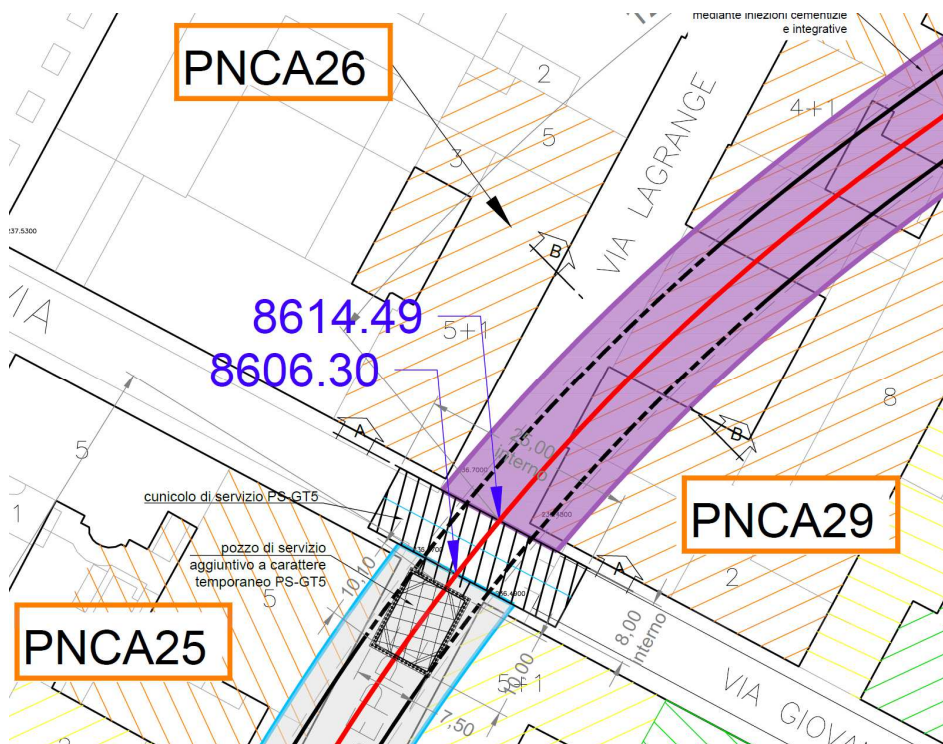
Planimetria dell'area in cui è ubicato il cunicolo PS-GT5.
